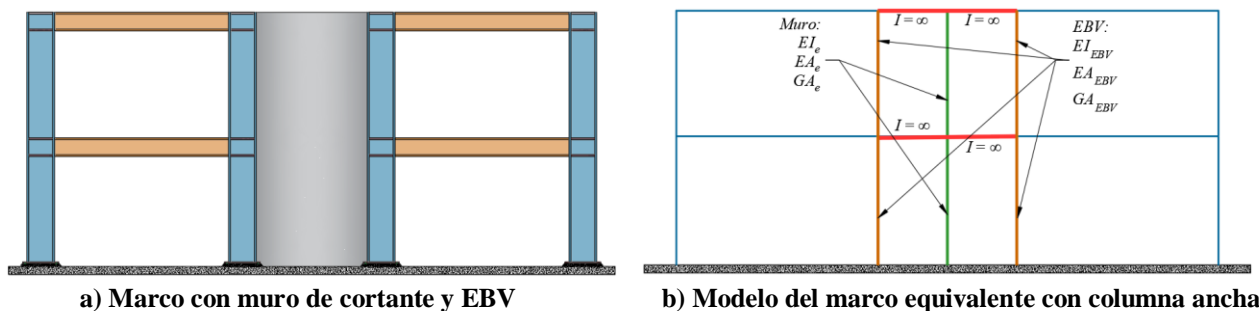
Modelado de marcos con muros planos con elementos de borde (EBV)
